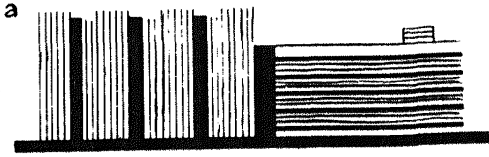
Использование узлов вертикального транспорта и лестниц для повышения пластической выразительности фасадов
